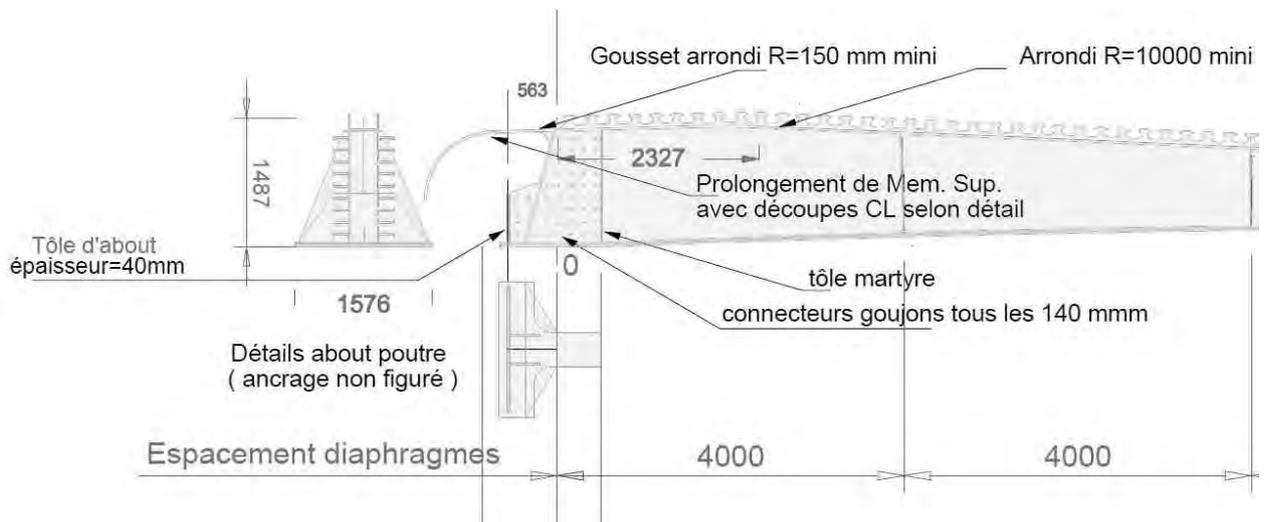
Ancrage de la membrure supérieure de la poutre à l'encastrement
